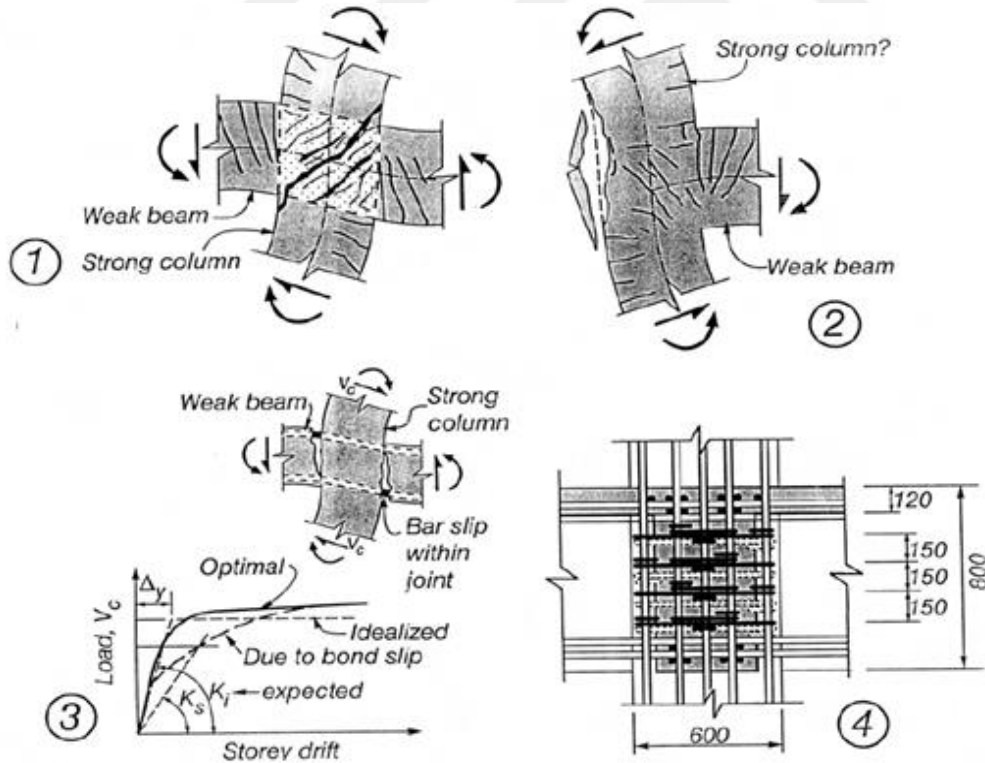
Kolon kiriş düğüm noktaları kuvvetli kolon - zayıf kiriş prensibi
